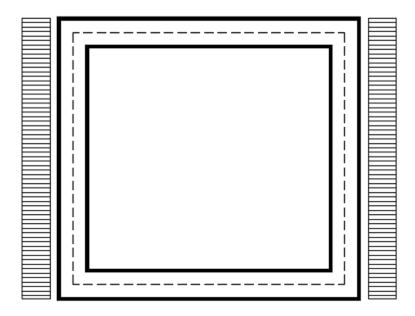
Schema tipo spinta carico accidentale su entrambi le pareti
